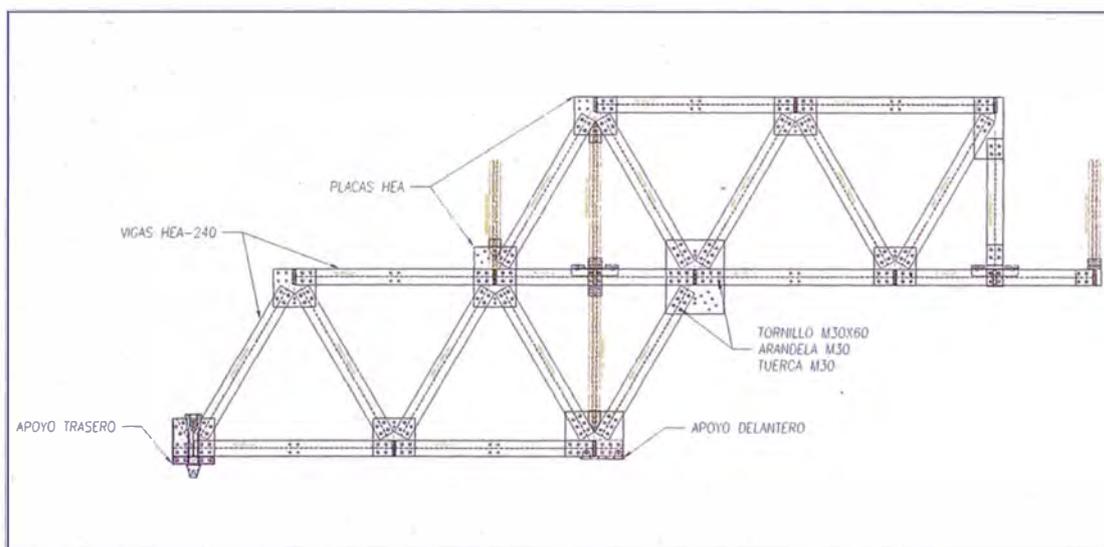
Alzado Estructura Principal - Fuente: Elaboración Propia
